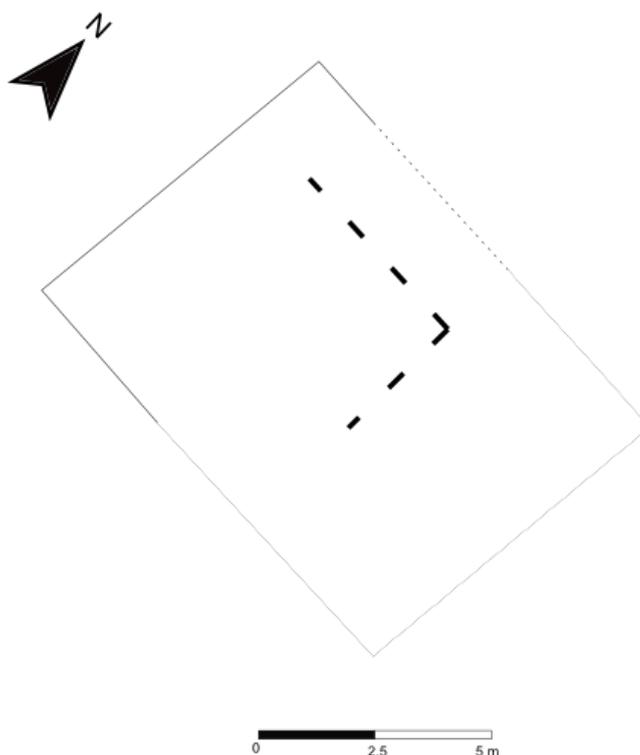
Planta do castelo de Alenquer com a fase 0 (tracejado a negro).
